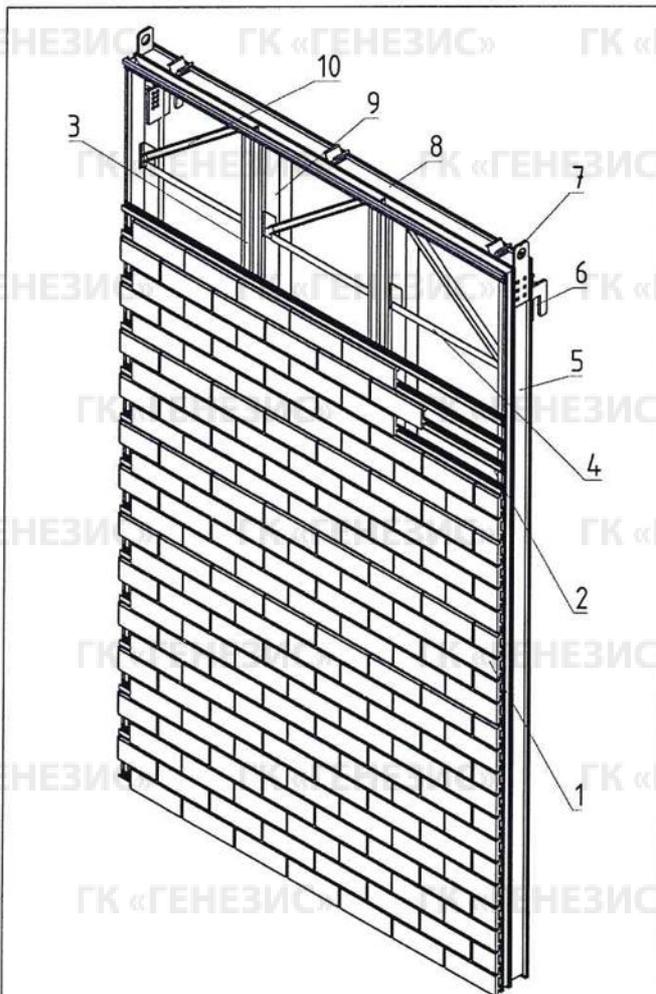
Общий вид модуля G-tech с частично снятой клинкерной плиткой
